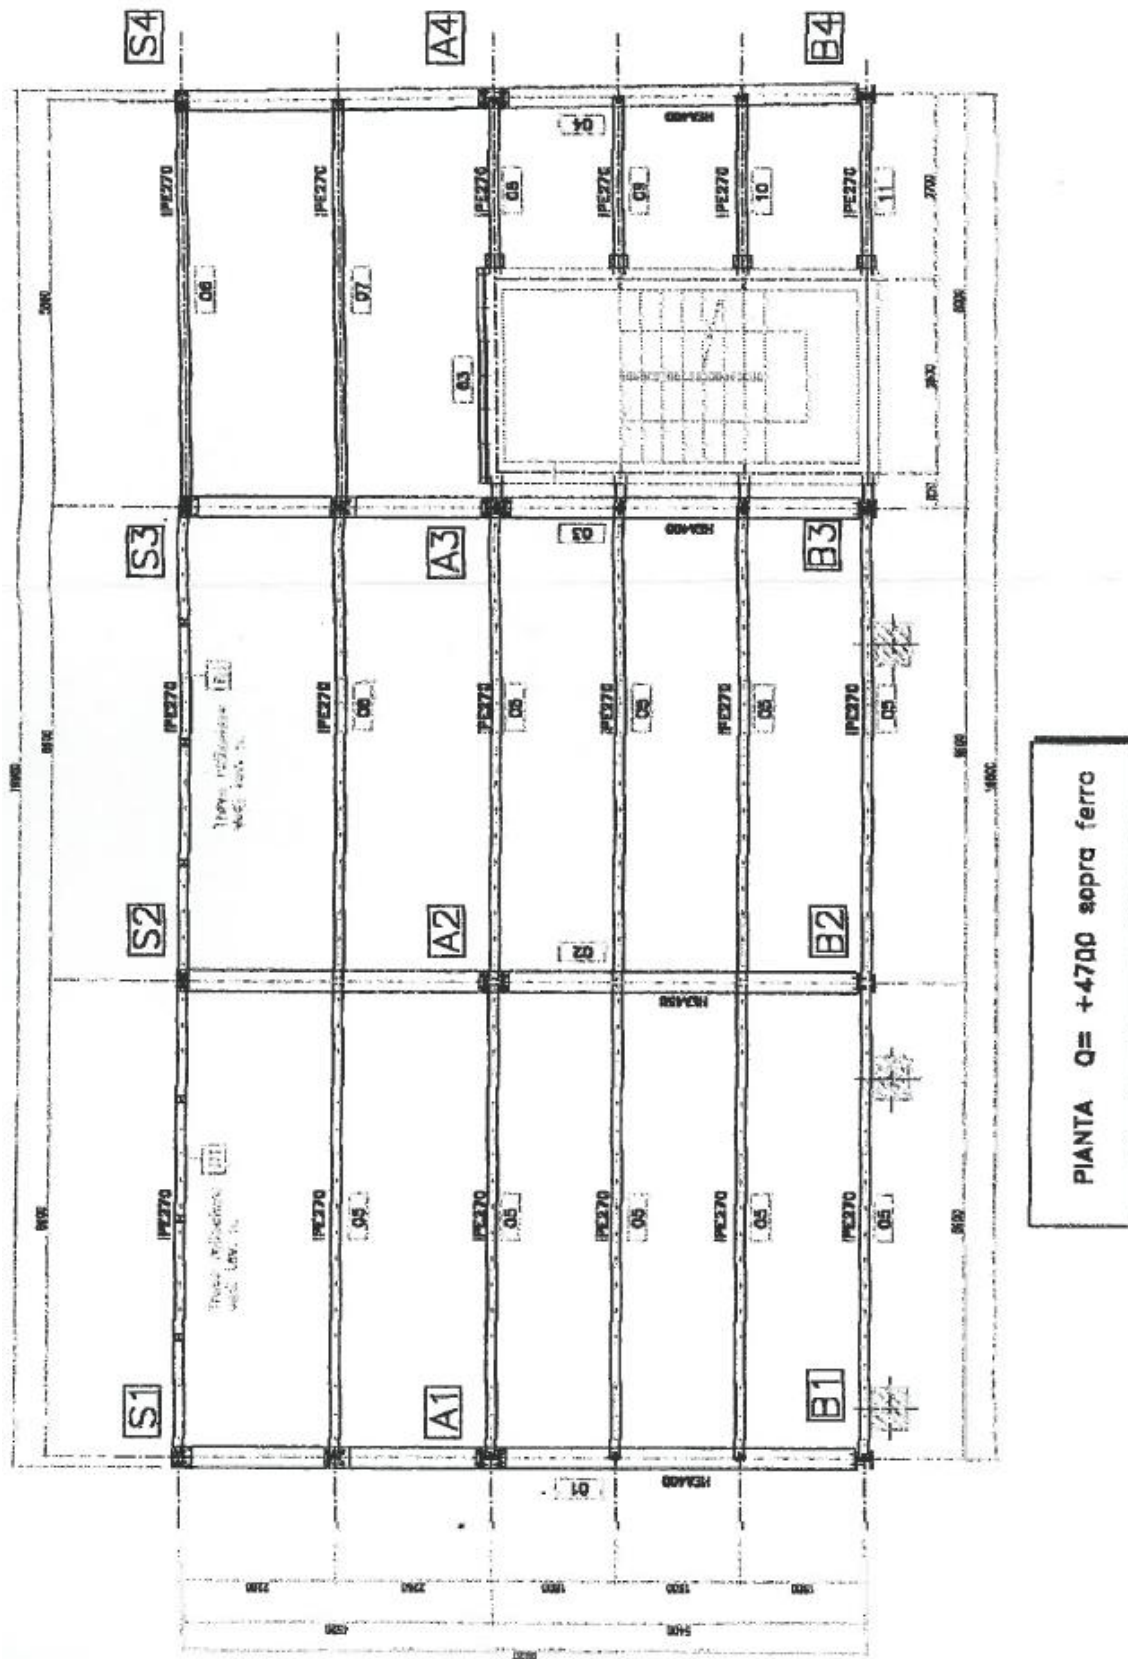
Particolare di A.2003.a.us.c.T12 - Piante generali - Pianta piano primo
